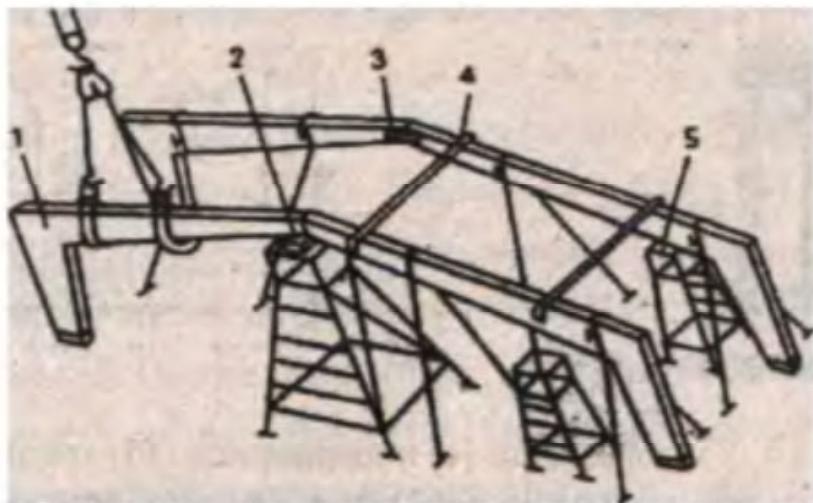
Схема монтажа клееных полурам: 1 -полурама; 2 -монтажная вышка с домкратом; 3 - накладка для крепления полурам; 4 -распорка для временного крепления и выверки; 5 -переставная вышка Пер первую установленную раму обычно раскрепляют тросами, последующие крепят к предыдущим прогонам или панелям покрытия. Если по каким-либо причинам немедленная установка элементов кровли невозможна, ставят временные связи по верхней кромке ригеля. Клееные рамы из прямолинейных элементов привозят на площадку в виде отдельных частей. До монтажа производится сборка их в полурамы, после чего они монтируются с помощью передвижной башни, как все трехшарнирные арки и рамы.
